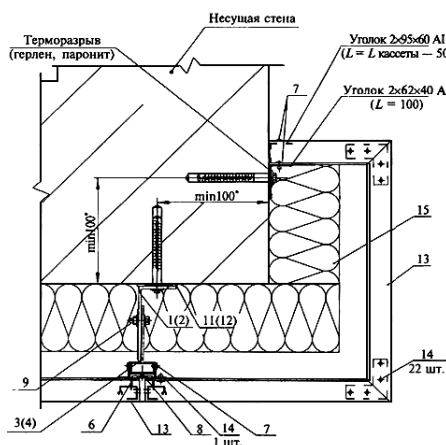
Узел крепления облицовочных панелей на наружном углу здания
